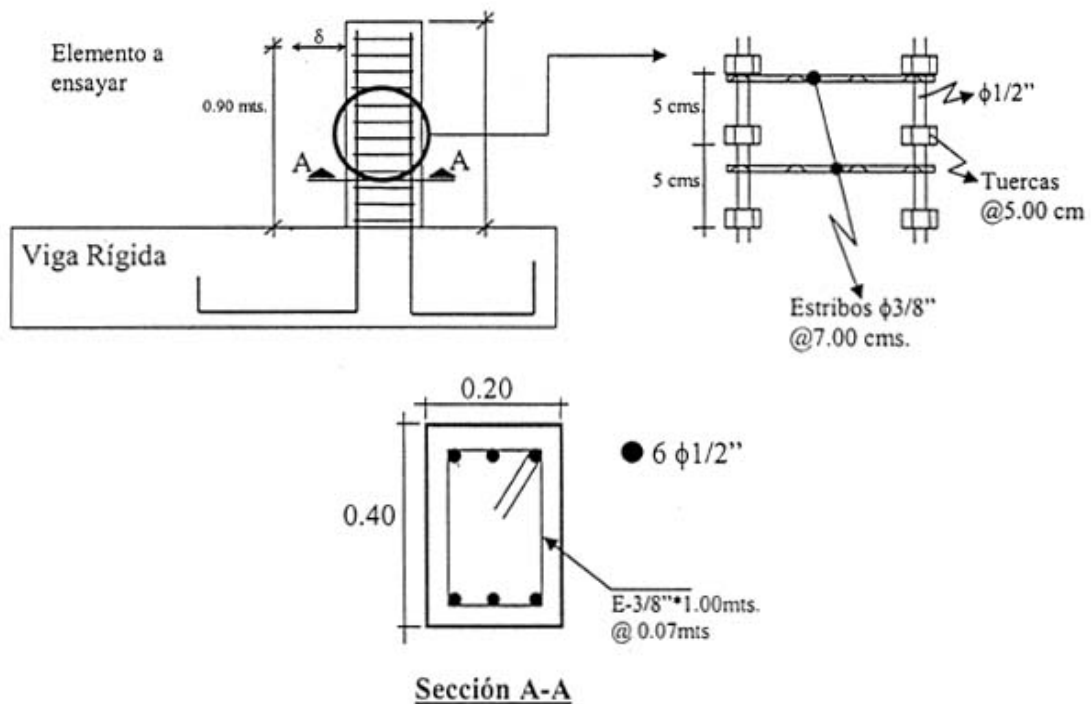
Detalles de la sección transversal de la probeta "CCT".
